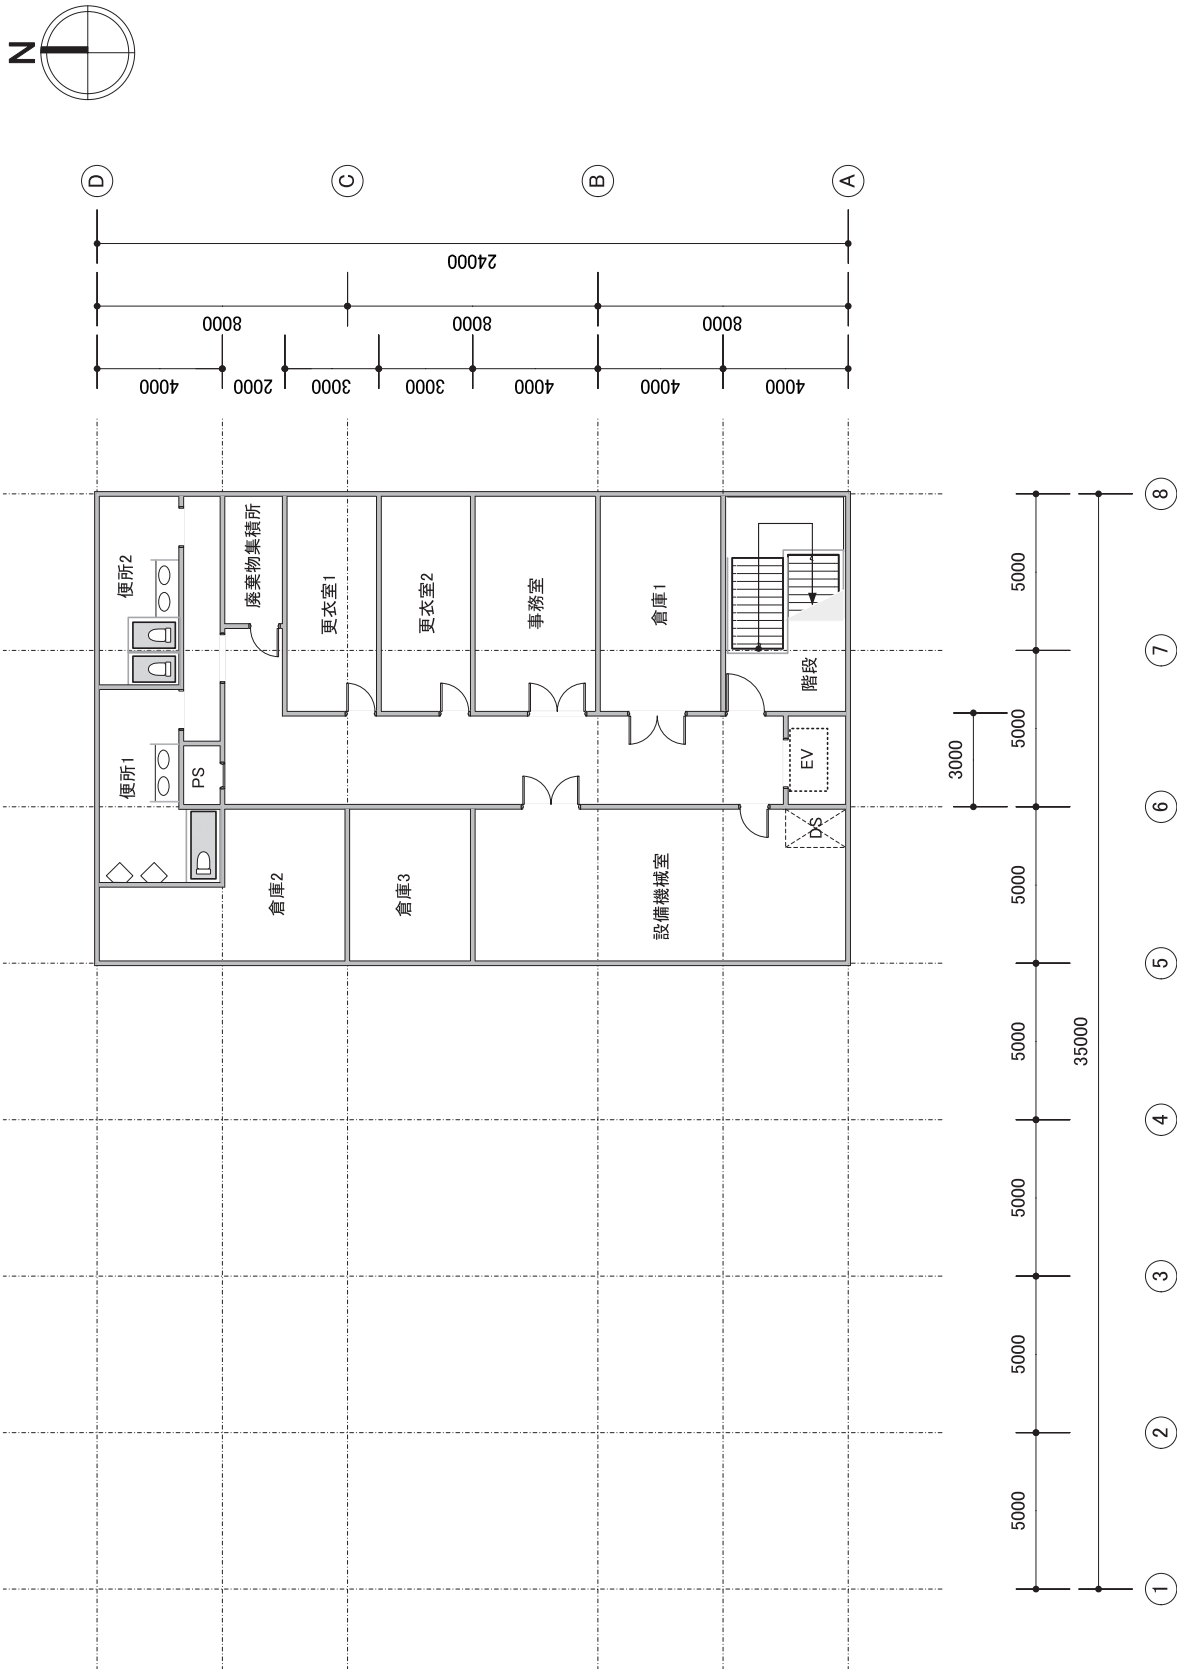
モデル建物（物販店舗等、5,000㎡）地下1階平面図
